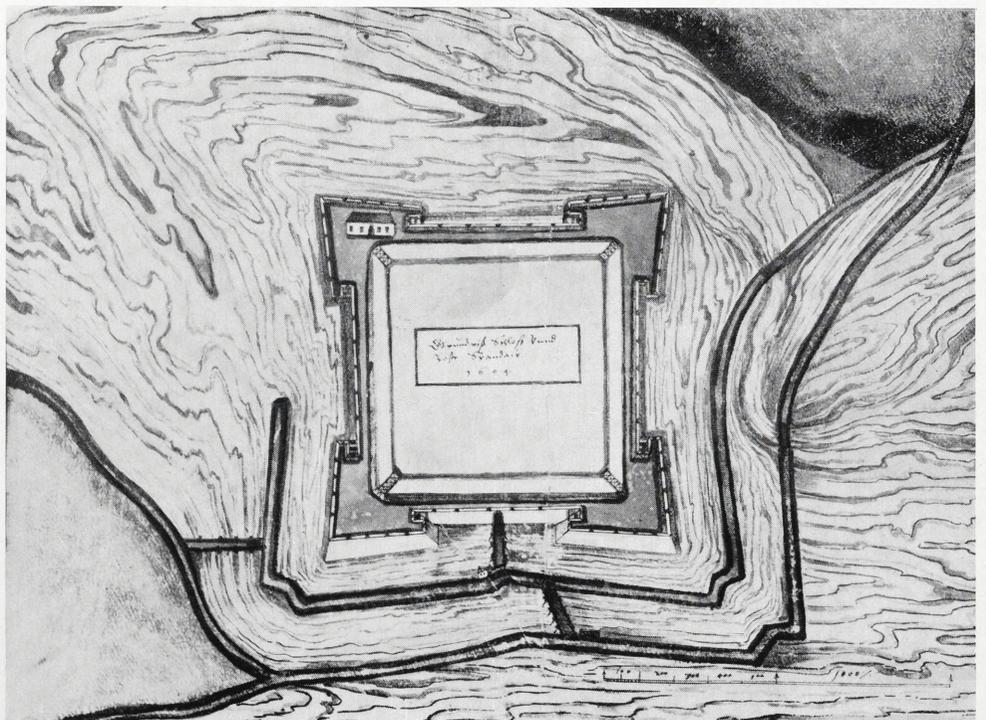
Grundriß von „Schloß Und Vöstung Spandaw“. Der Grundriß ist stark reduziert
